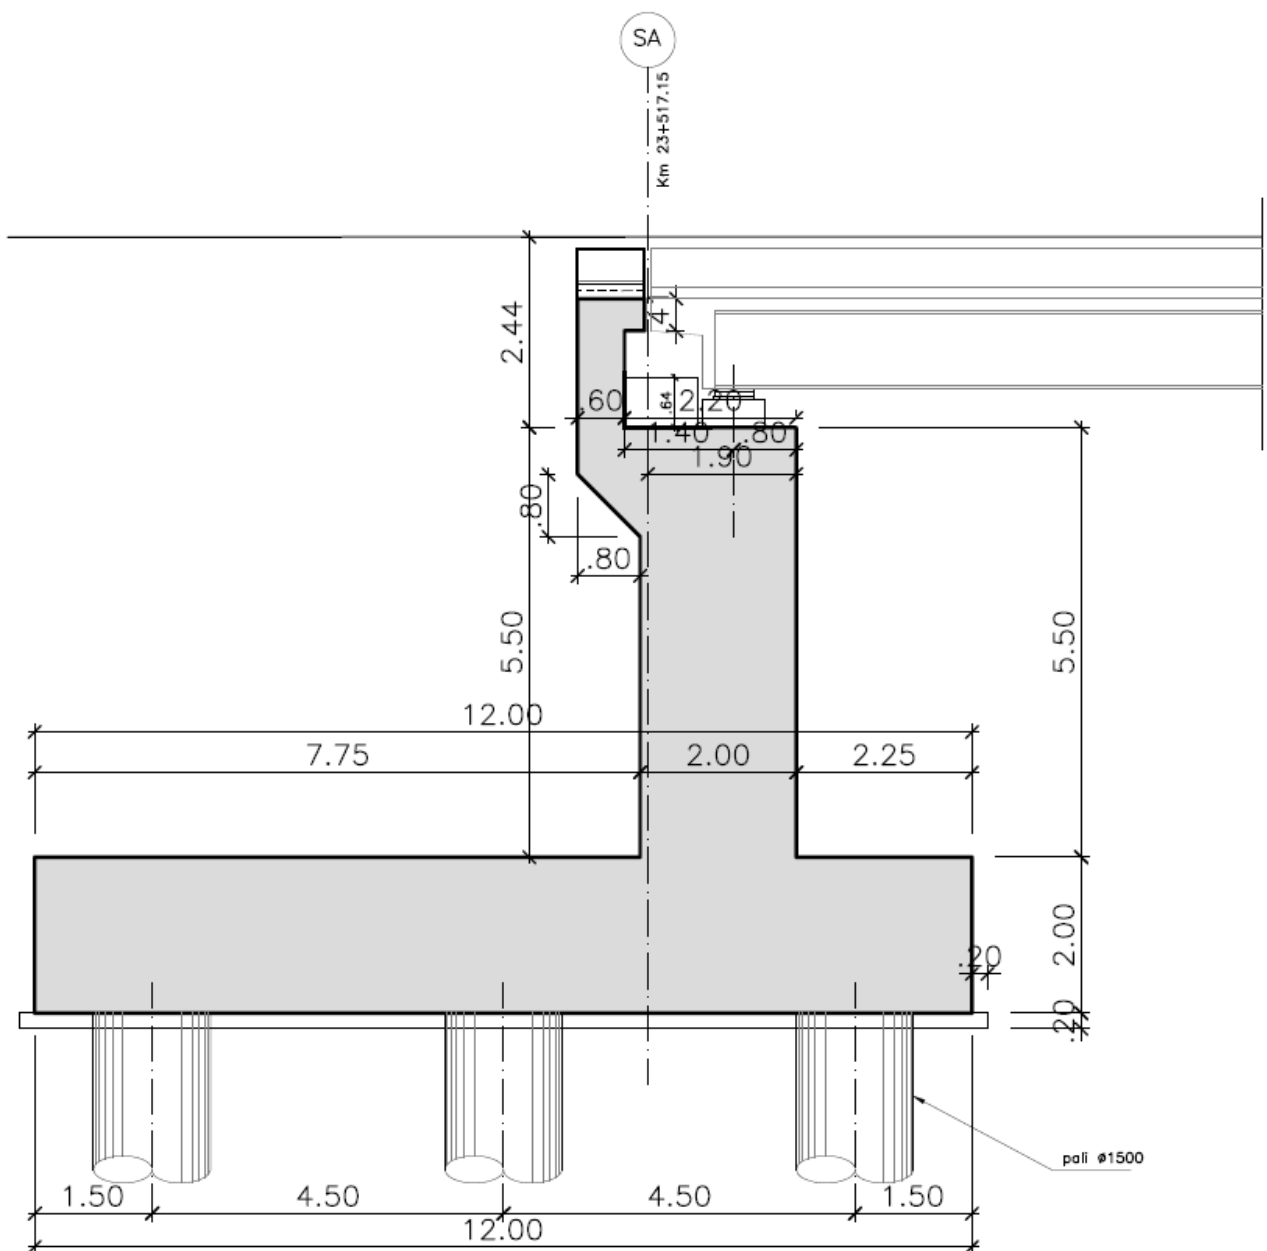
Sezione longitudinale Spalla “A”.
